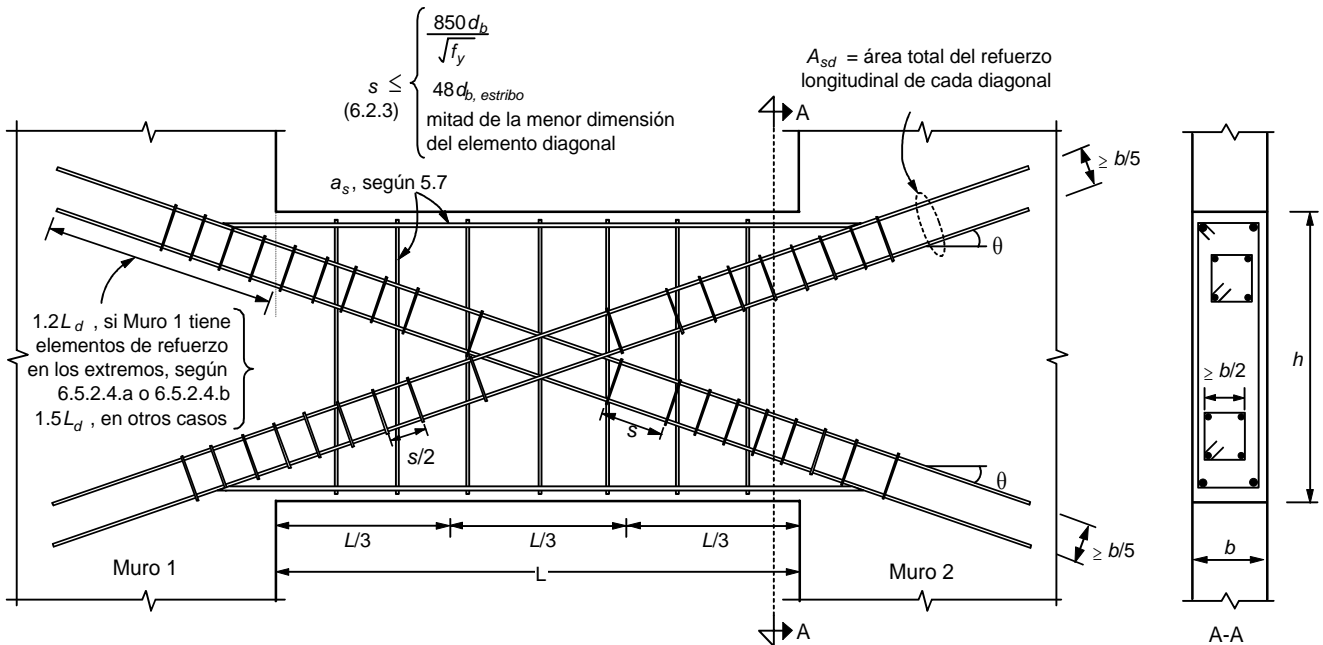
Refuerzo de una viga diafragma que une muros sujetos a fuerzas horizontales en su plano
